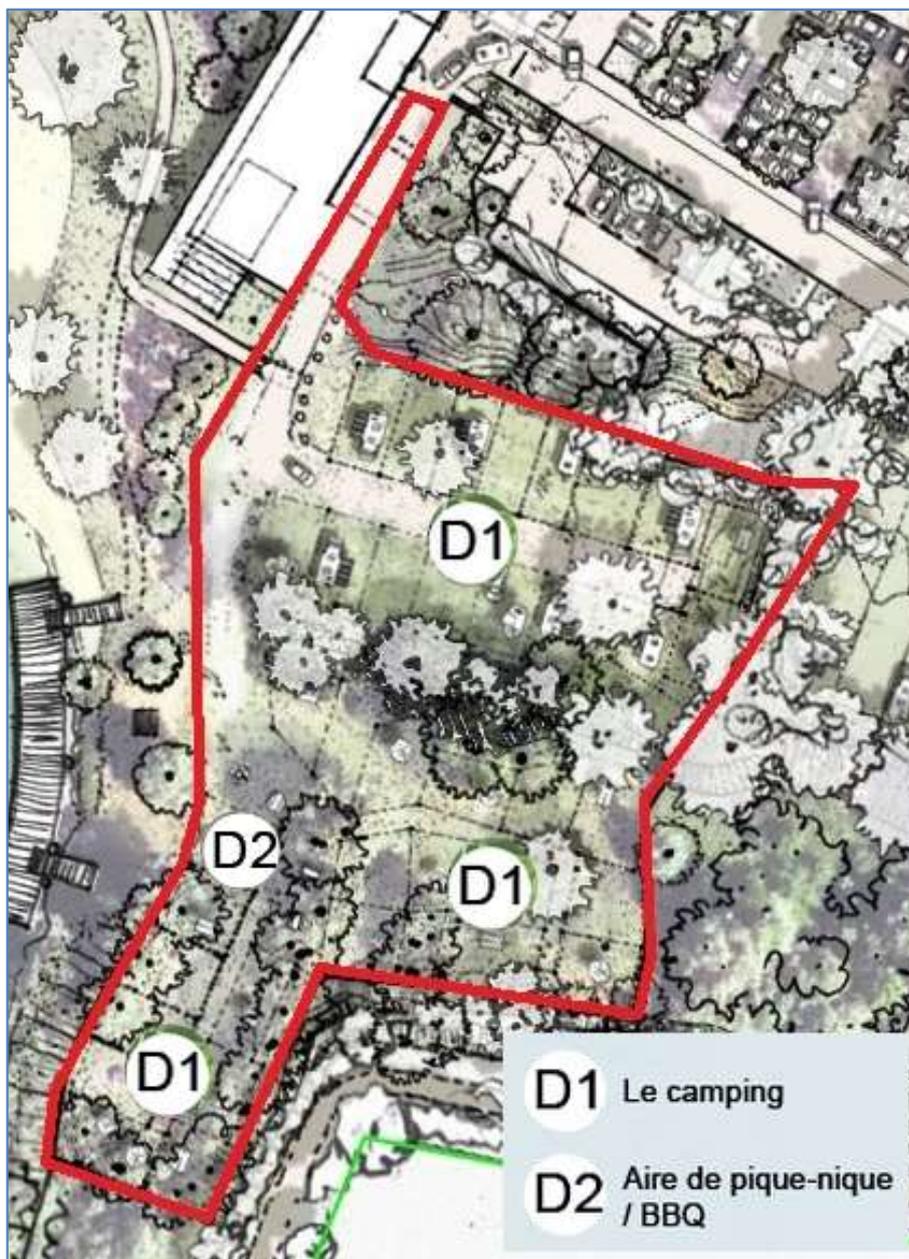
Plan de masse du projet – Zoom sur le camping (GBM, 05/2022)
